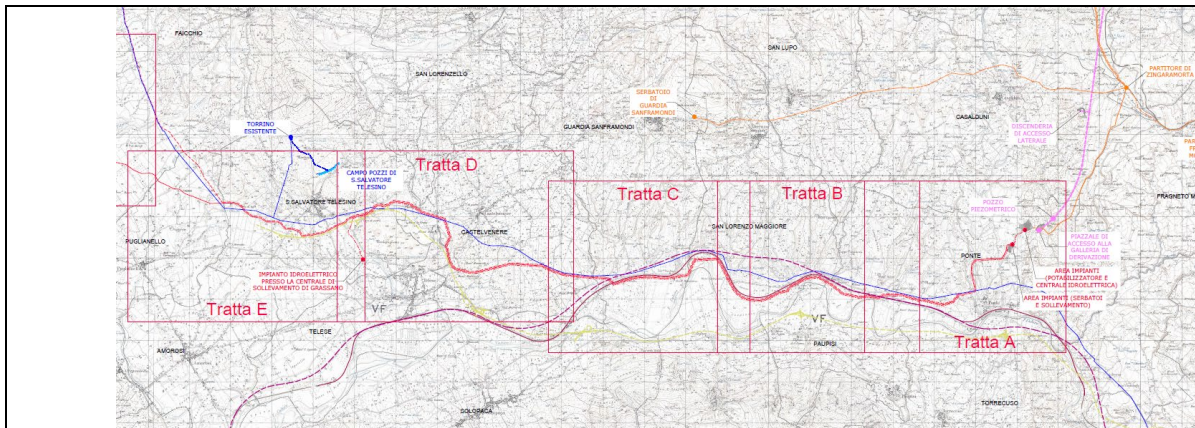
Planimetria condotta adduzione ACAM (in rosso)
